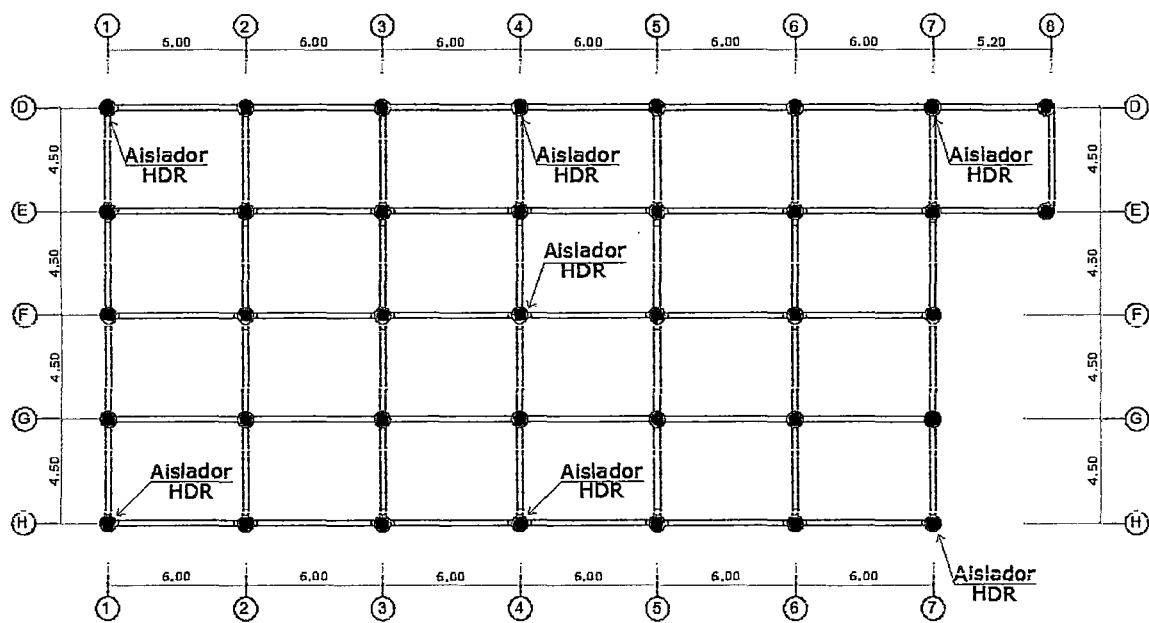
Configuración del sistema de aislamiento del primer caso:HDR
